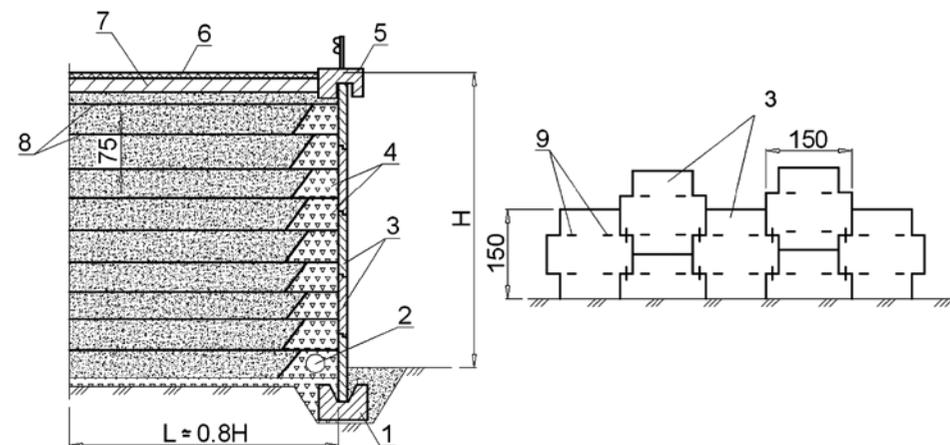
Вариант армогрунтовой подпорной стены с железобетонными сборными блоками лицевой стенки:
